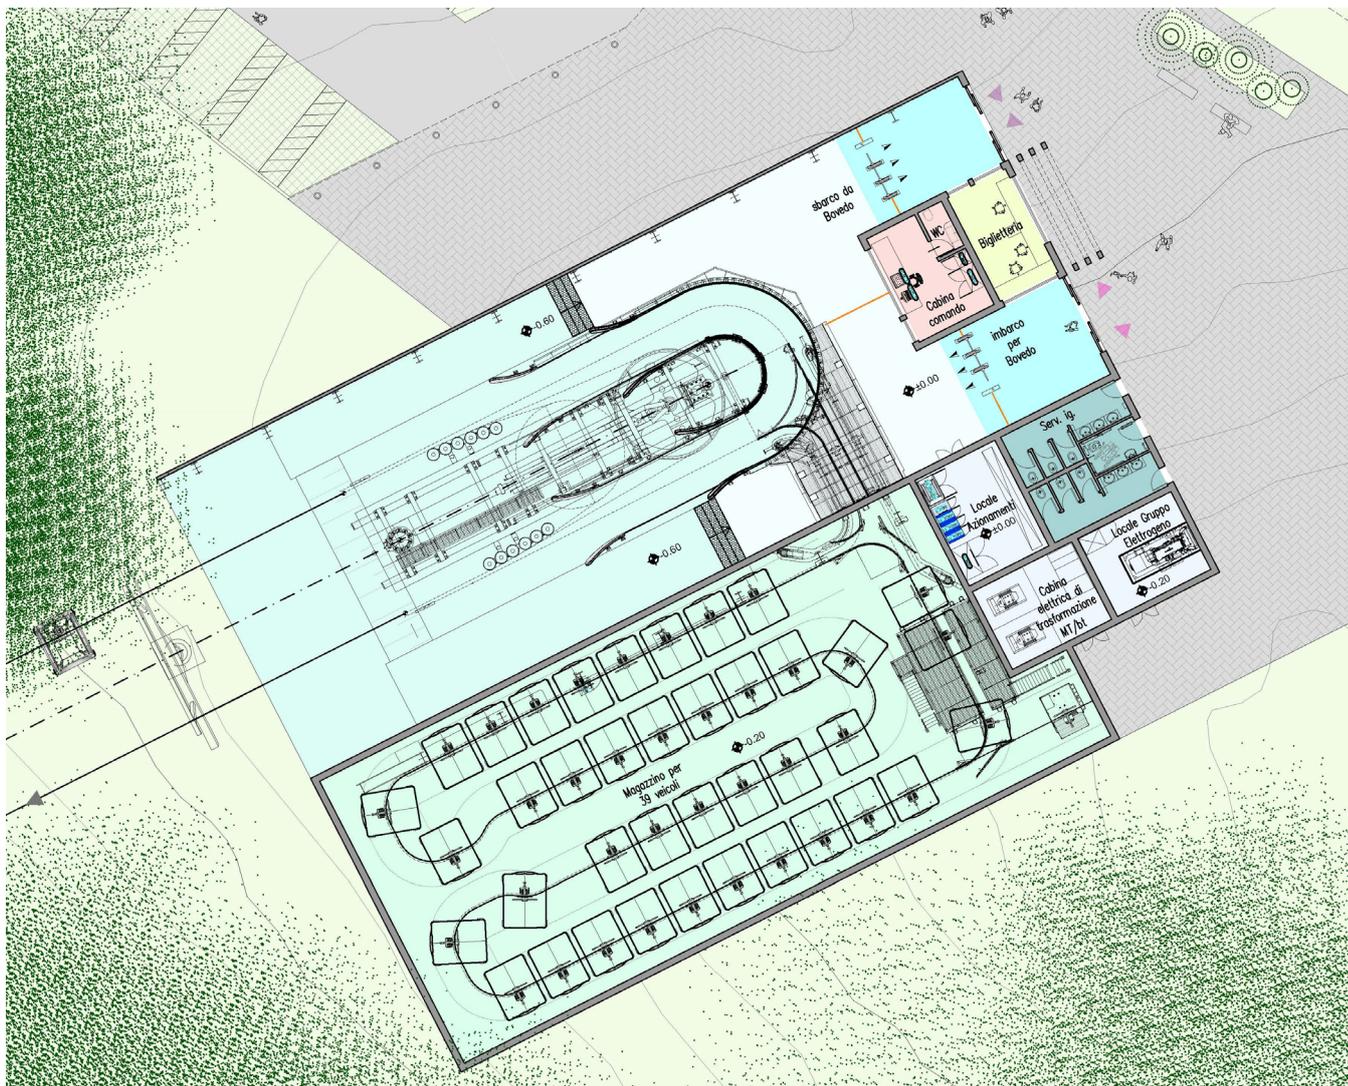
Planimetria stazione terminale ad Opicina e distribuzione interna dei locali.
